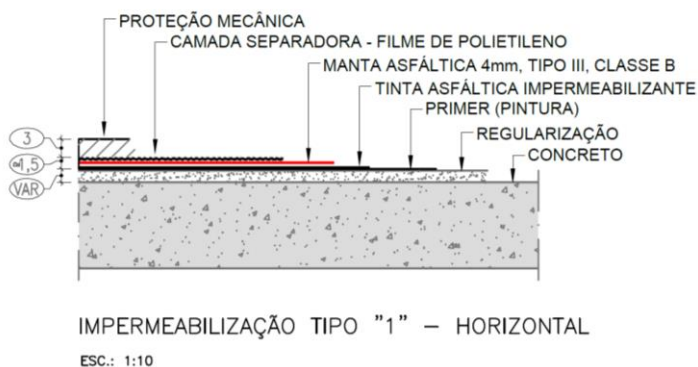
Detalhe construtivo de impermeabilização - base.
